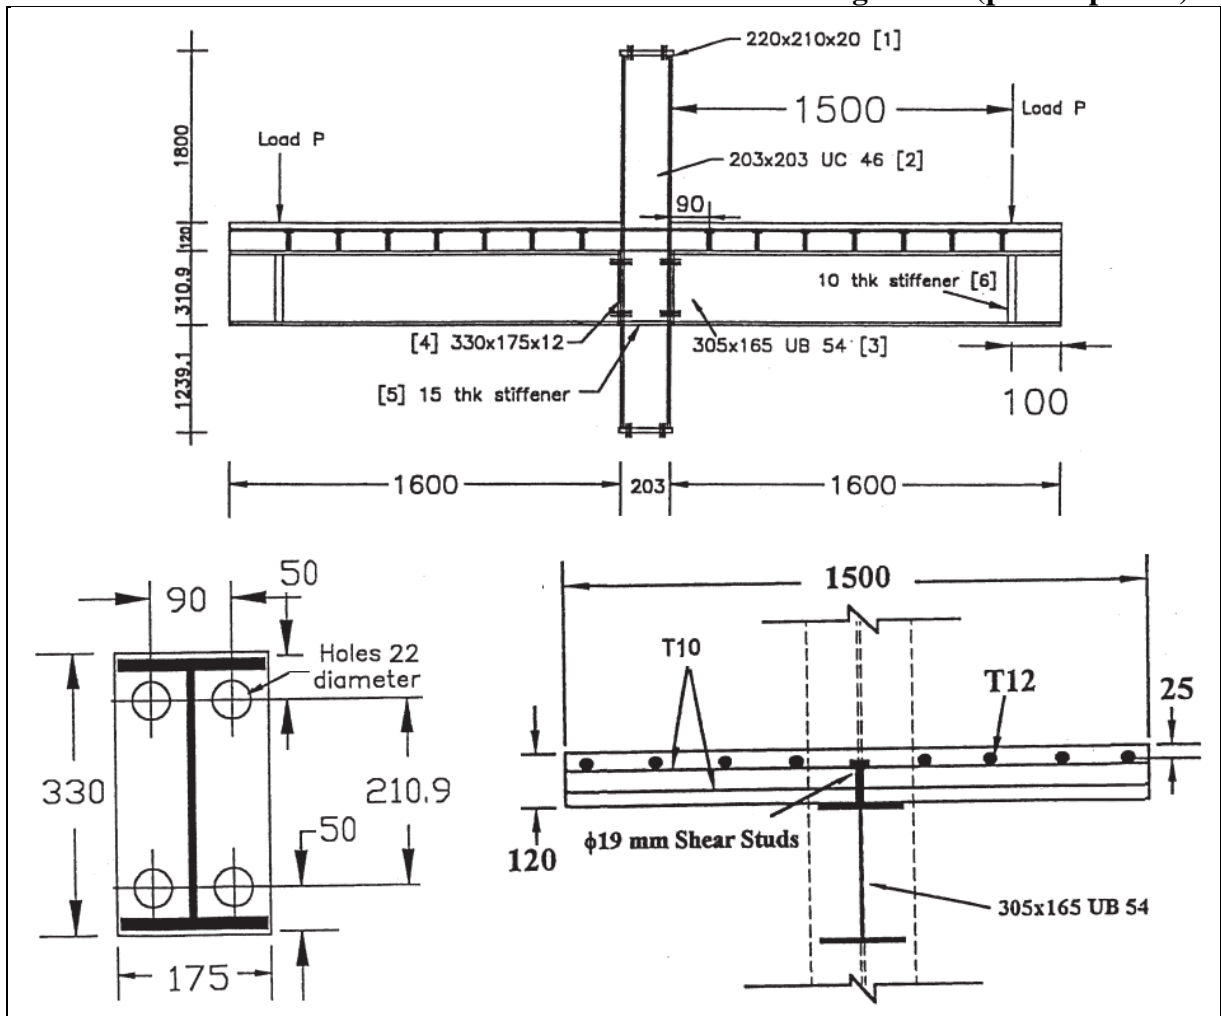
Assemblage mixte (poutre-poteau) par plaque d'extrémité boulonnée testé par Richard Liew
